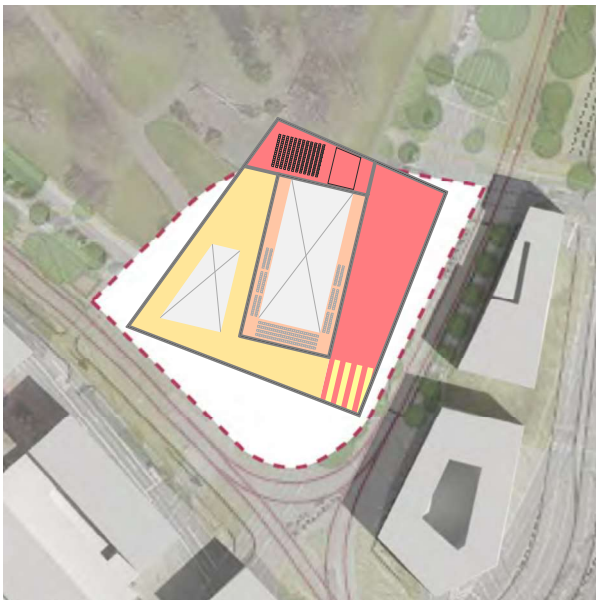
Grundriss OG2 Bahnhofsquartier V1
